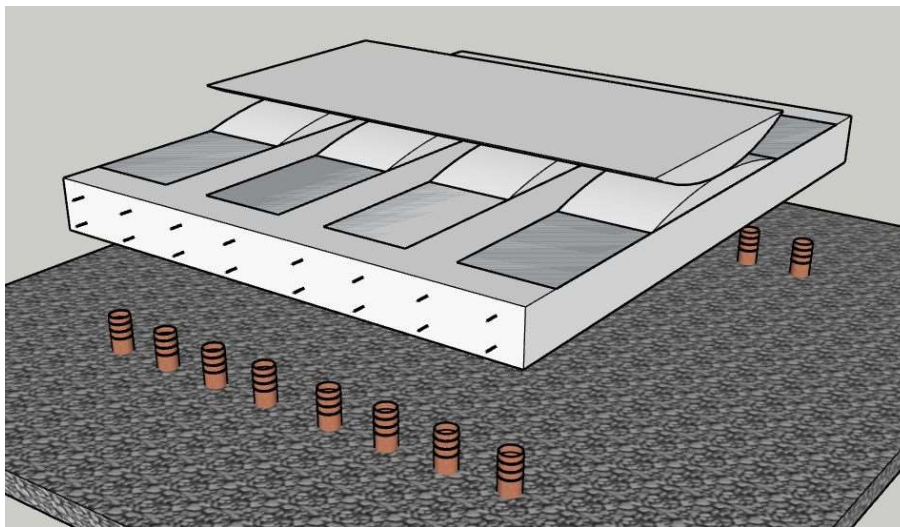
基礎部と杭の接合イメージ（コンクリート基礎）
